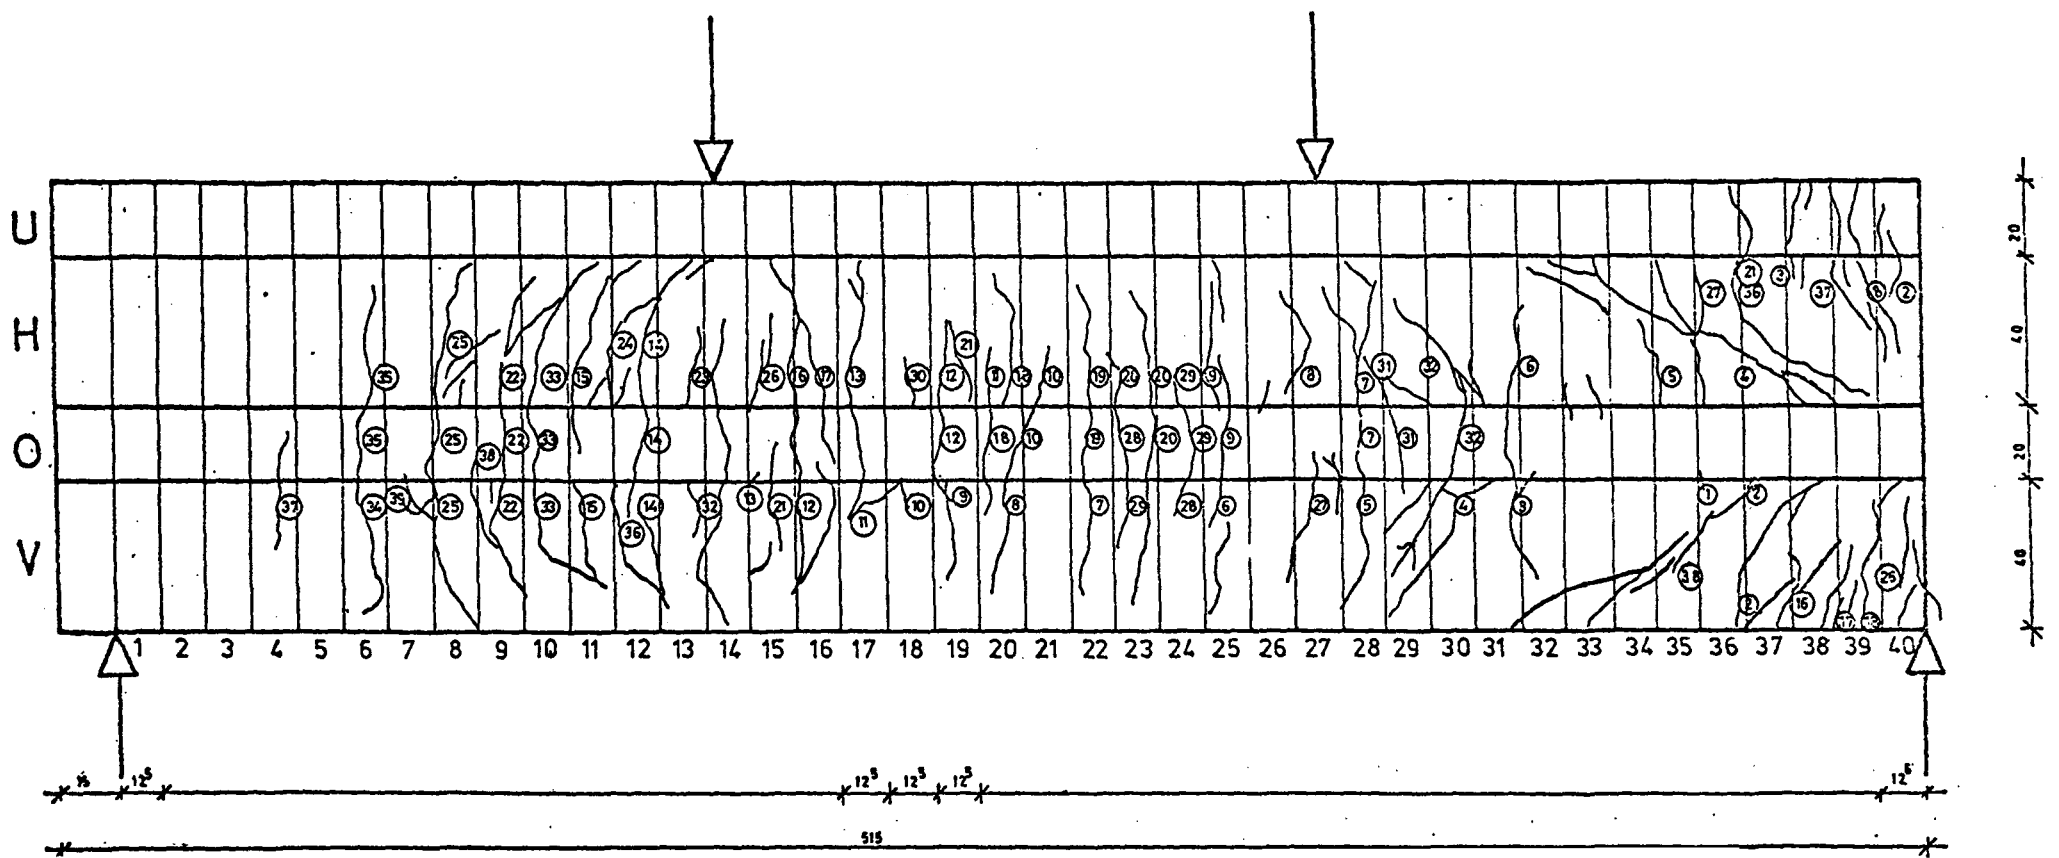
Rissbild von Balken B II in Laststufe 18 mit Angabe der Rissnummer
